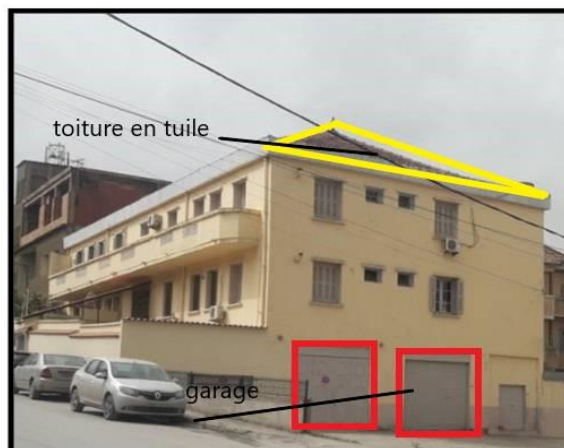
photo d'une maison individuelle avec une toiture en tuile
